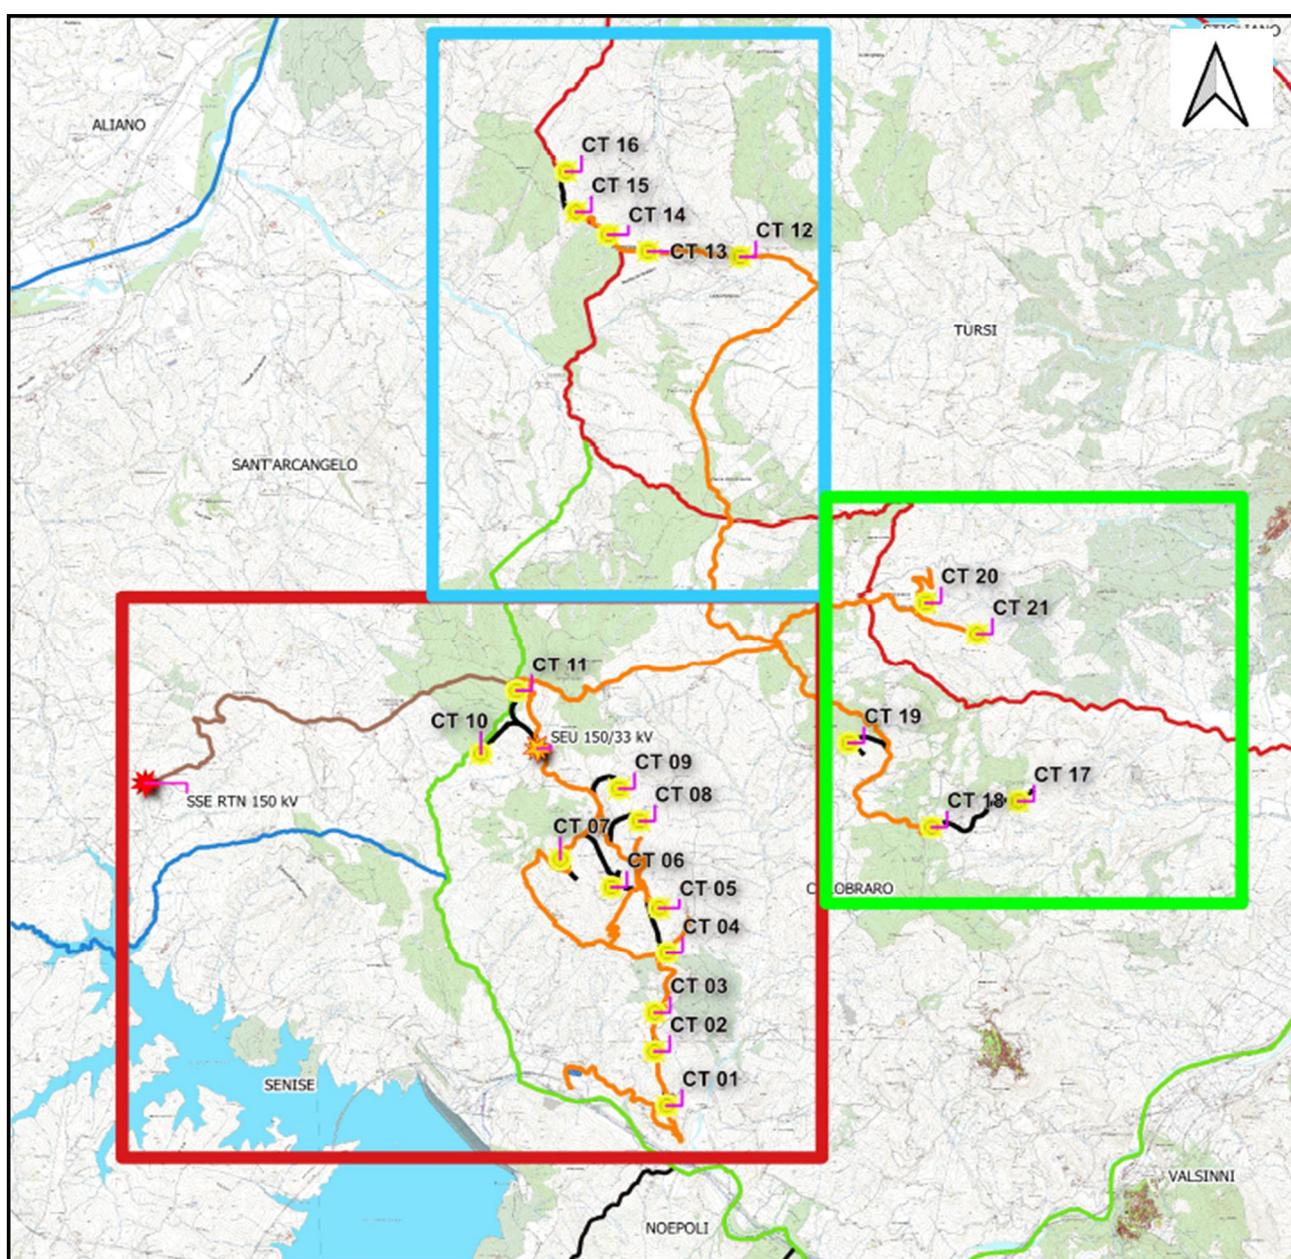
Layout d’impianto suddiviso in zone su CTR: Zona 1 (rettangolo rosso), Zona 2 (rettangolo azzurro), Zona 3 (rettangolo verde)
